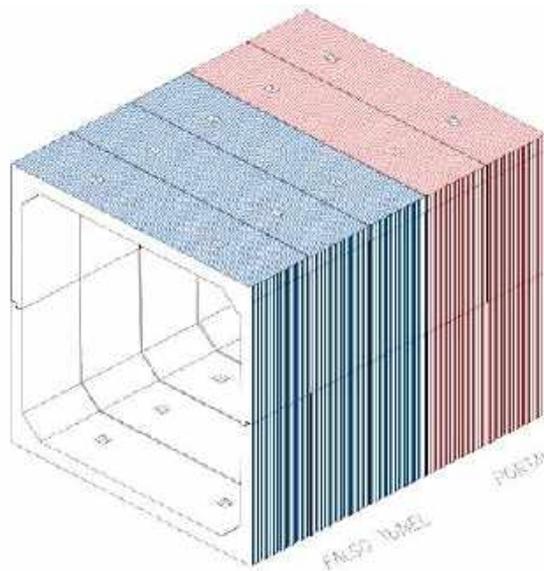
Vista isométrica de falso túnel y portal de concreto armado prefabricado
